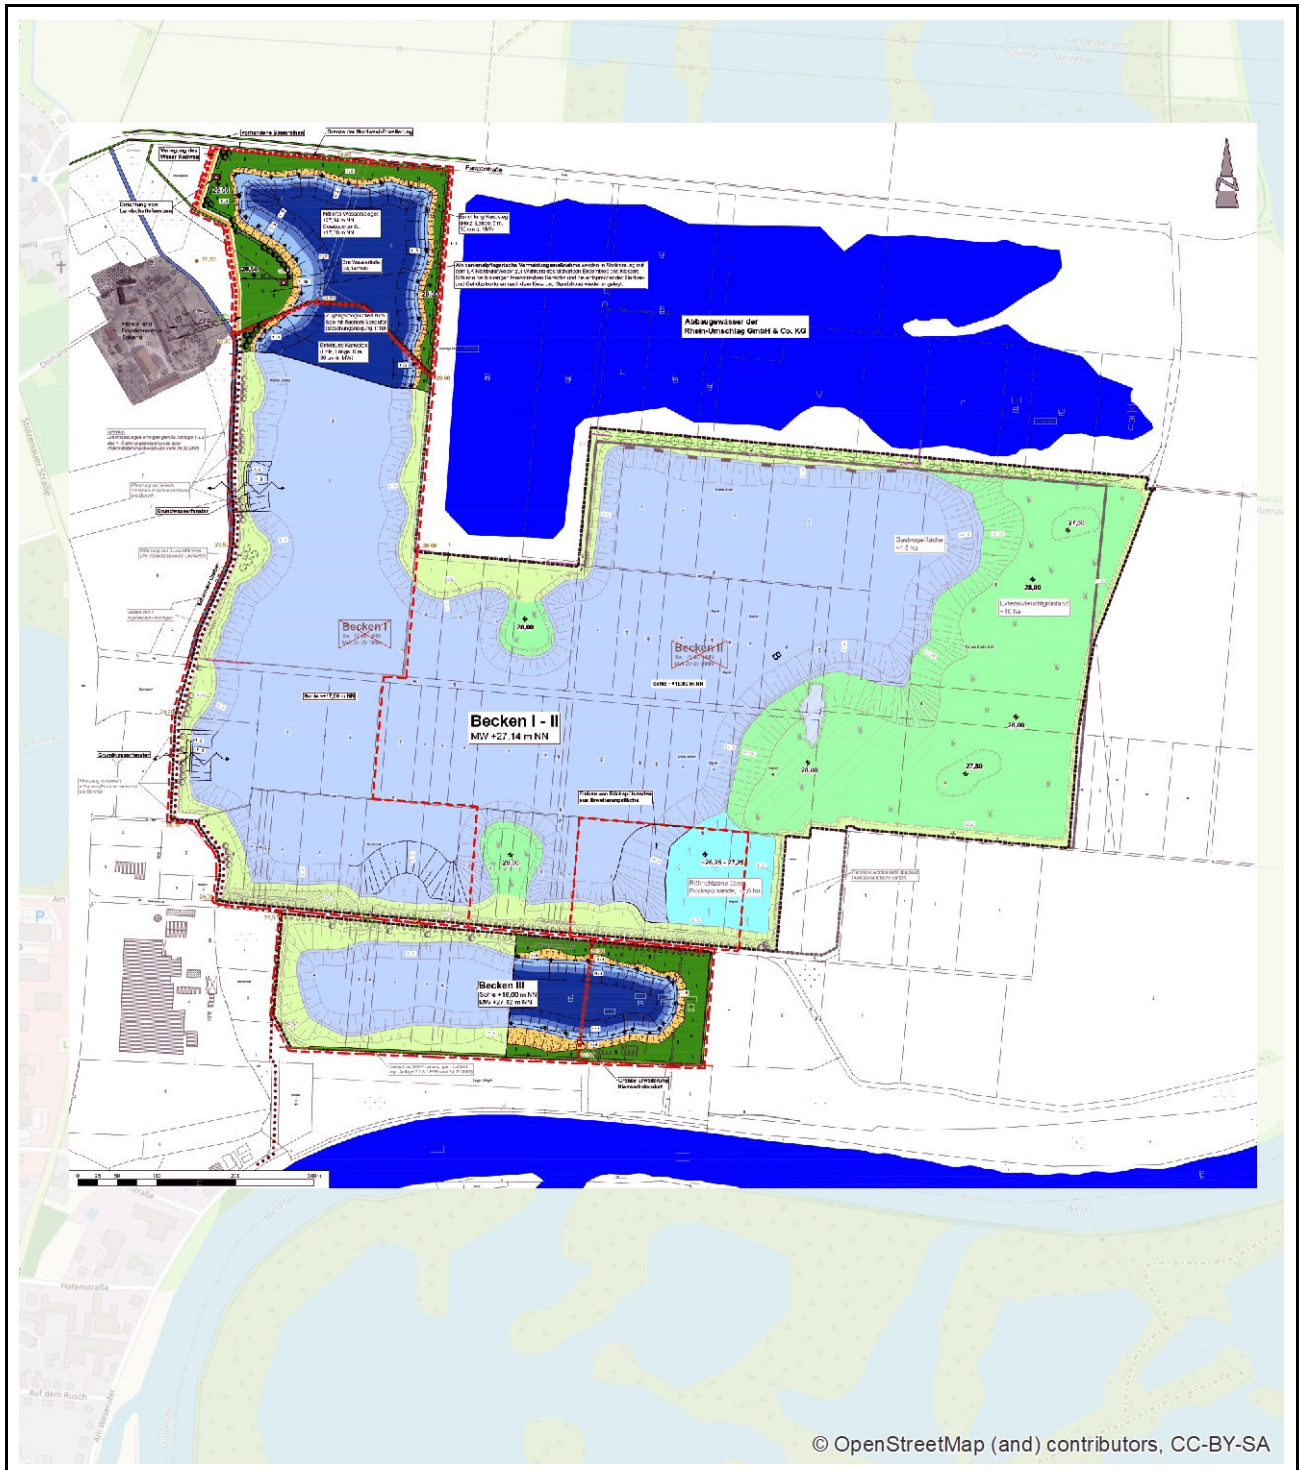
PLAN-Zustand - Rekultivierungsplan (Erweiterung dunkelblau und dunkelgrün)
